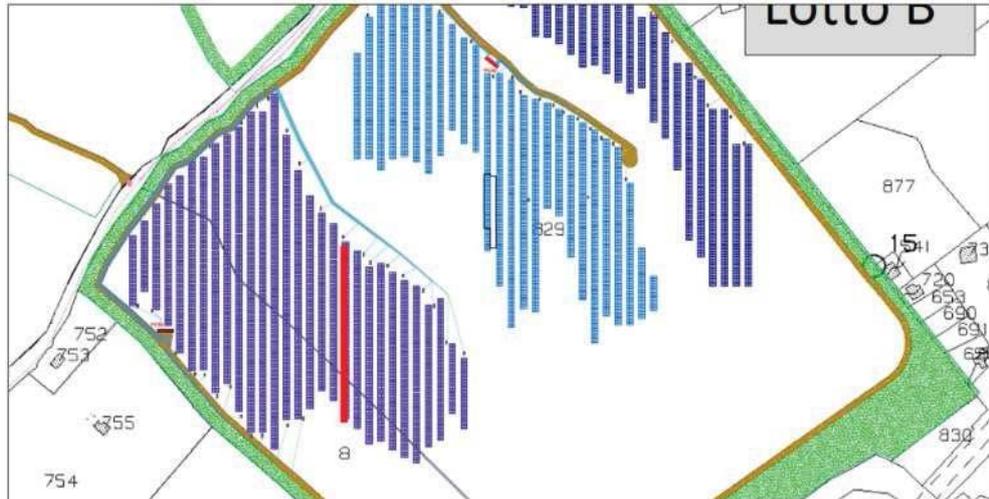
Lotto B (Profilo: linea rossa in direzione Nord-Sud)
